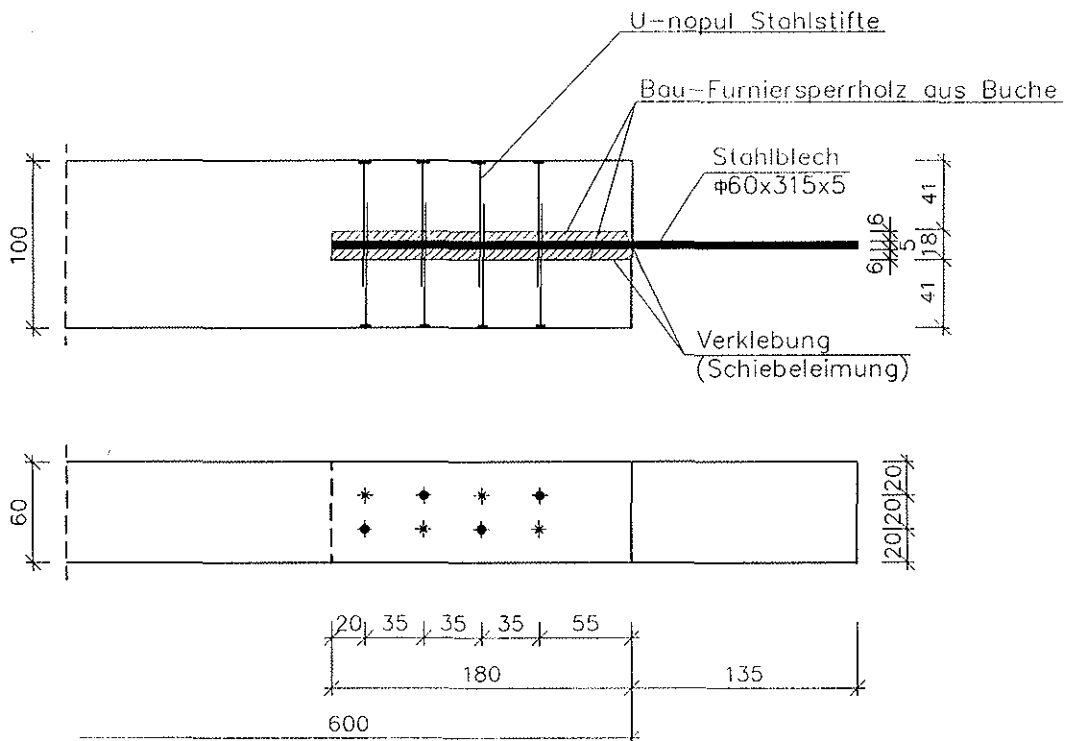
BFU-BU verstärkte Stahlblech-Holz-Verbindung mit nicht vorgebohrten Stahlblechen und U-nopul-Stahlstiften
